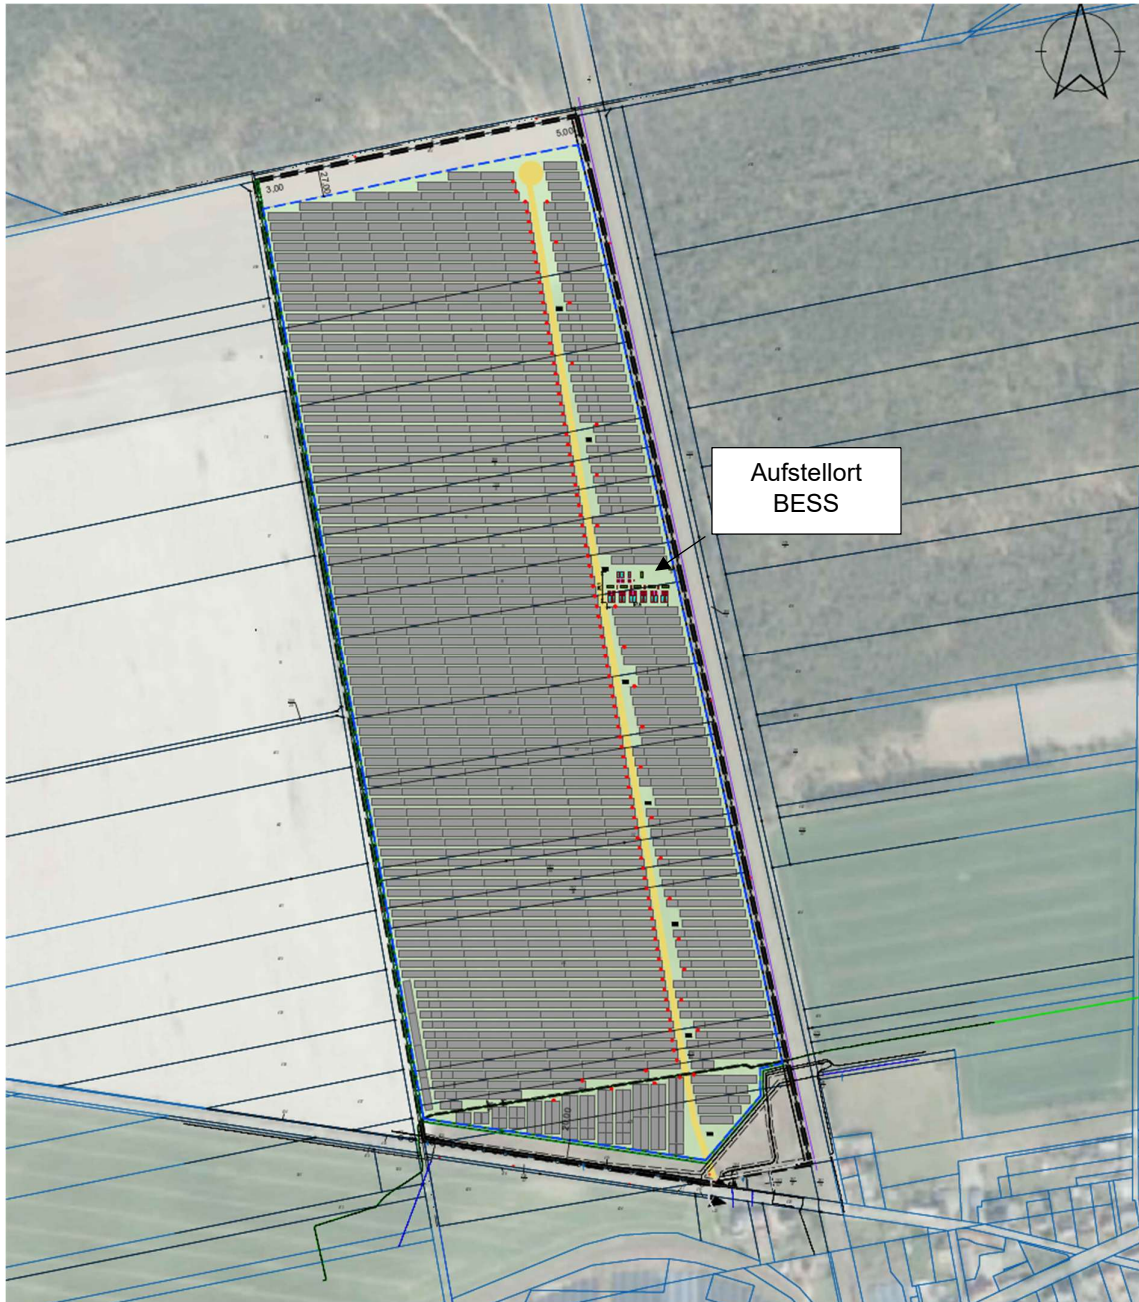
Layout der geplanten PVA inkl. BESS - Quelle: Kunde
